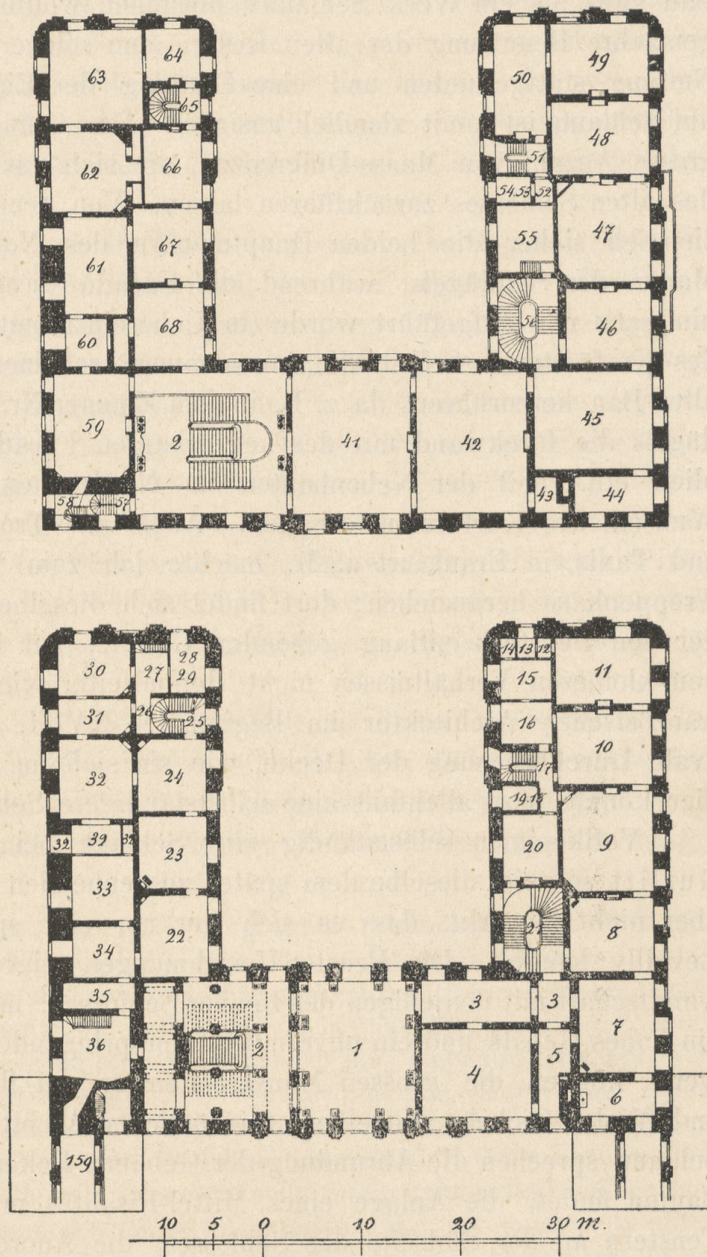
Brühl, Grundriss des Schlosses (nach Dohme-Rückwardt „Das kgl. Schloss zu Brühl“).
